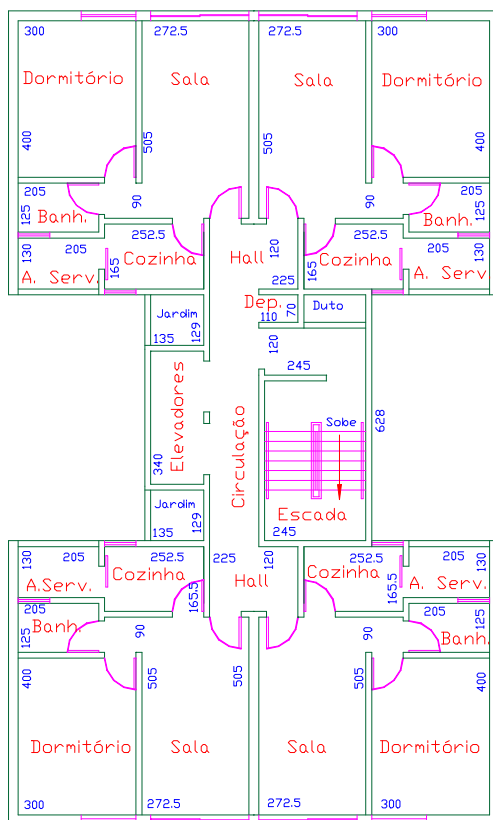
Edifício Exemplo: Planta Baixa Pavimento Tipo (x10)
